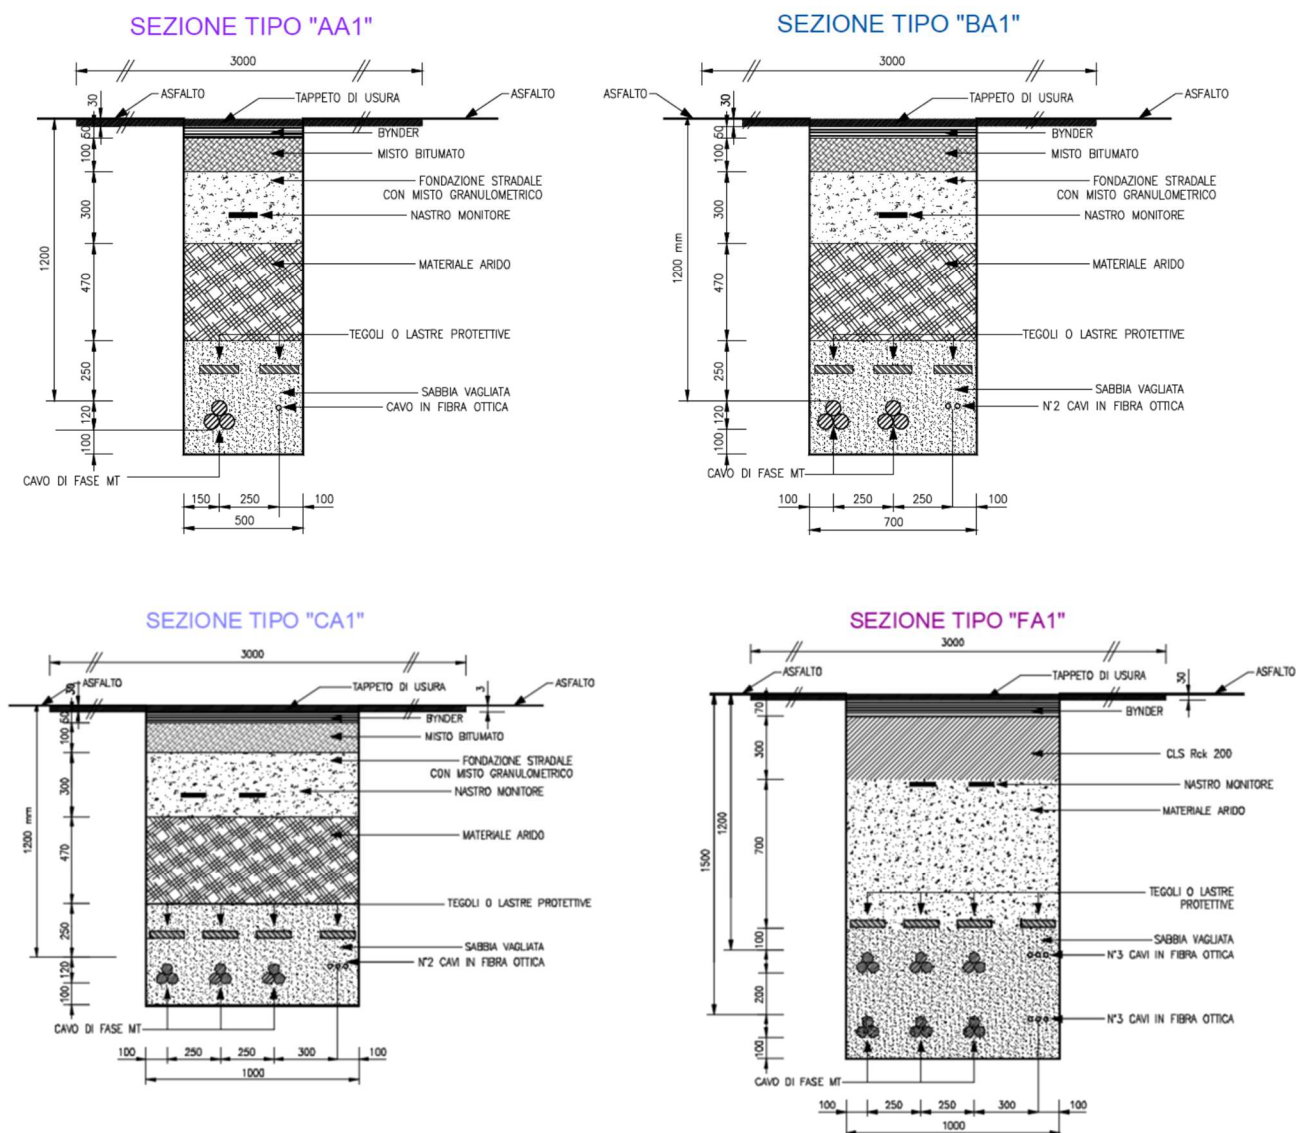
Sezione tipica di posa della linea in cavo su sede stradale
